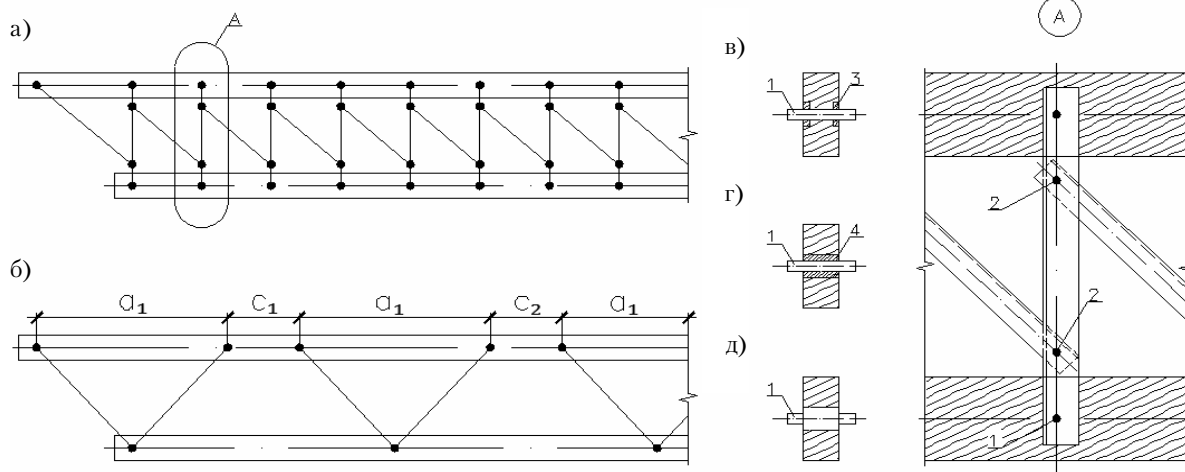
Конструктивное решение металлодеревянных ферм построечного изготовления: а) ферма с нисходящими раскосами; б) ферма рамная; в) нагель с шайбами; г) нагель с втулкой; д) нагель с уширением; 1 – нагель; 2 – болт; 3 – шайба; 4 – цилиндр.
